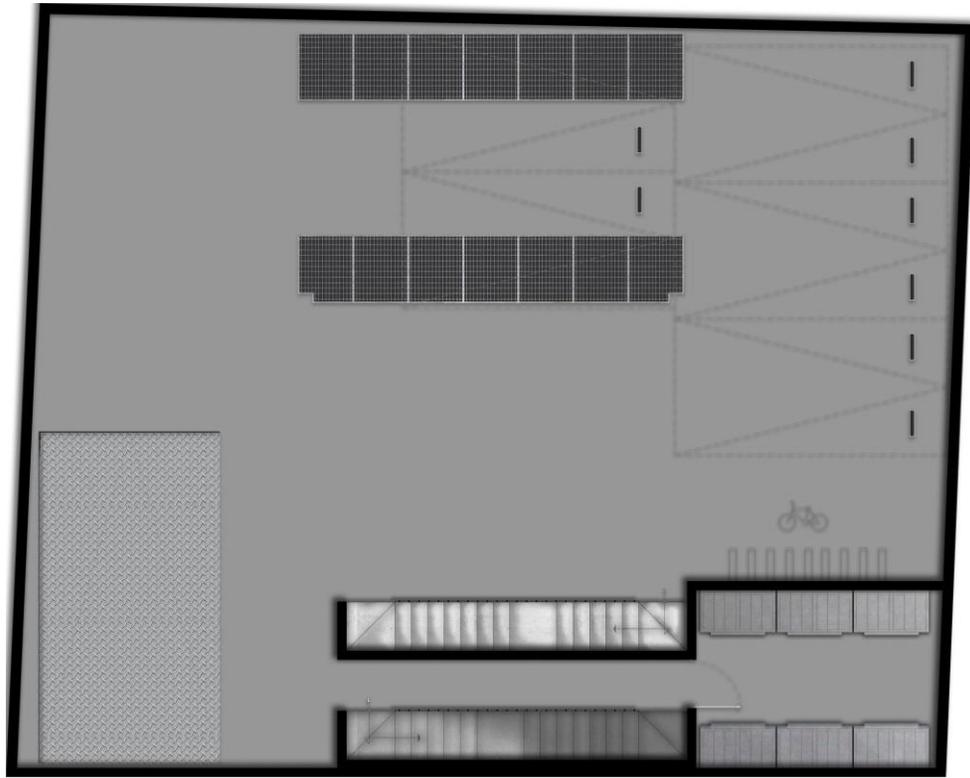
Planta tipo de sótano, desarrollo de anteproyecto.
